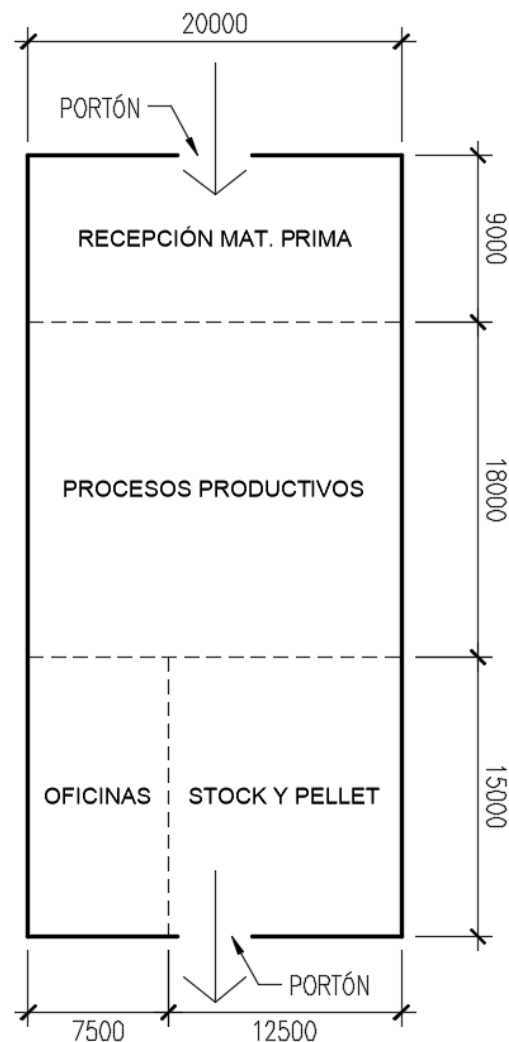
Distribución de sectores en planta (medidas en mm). Fuente: Elaboración propia.
